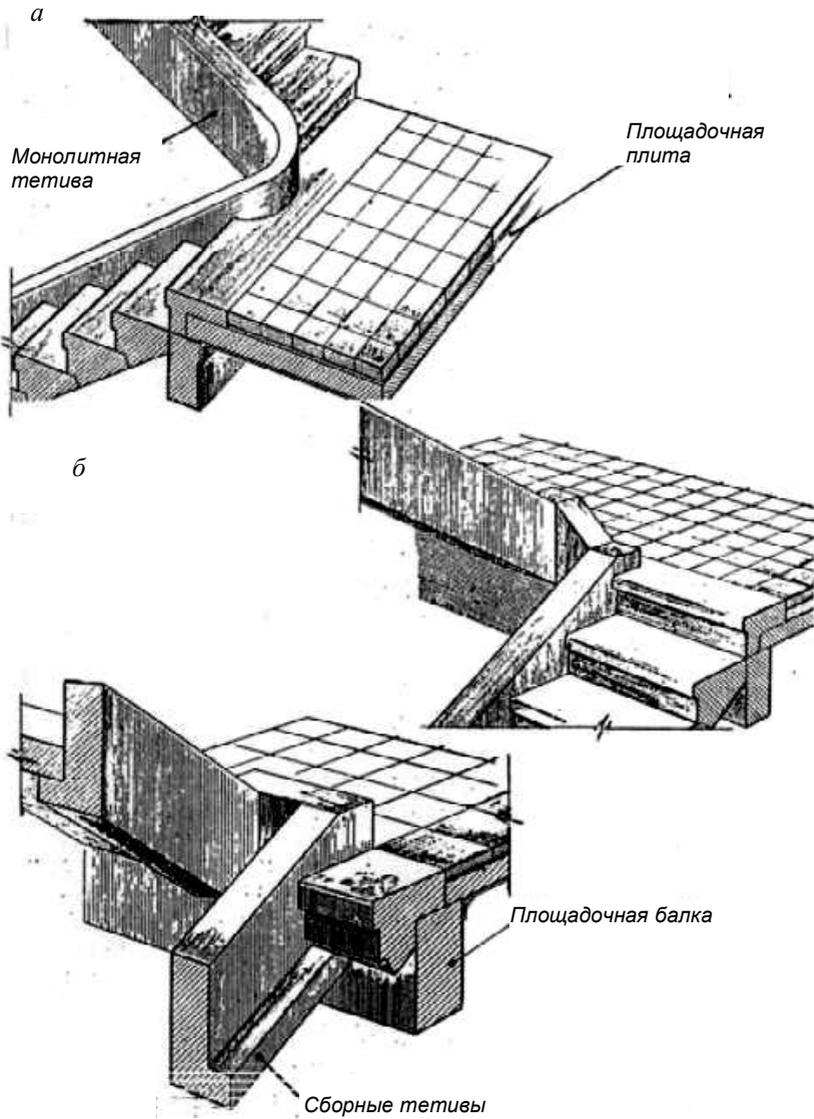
Общий вид лестниц на железобетонных тетивах:
